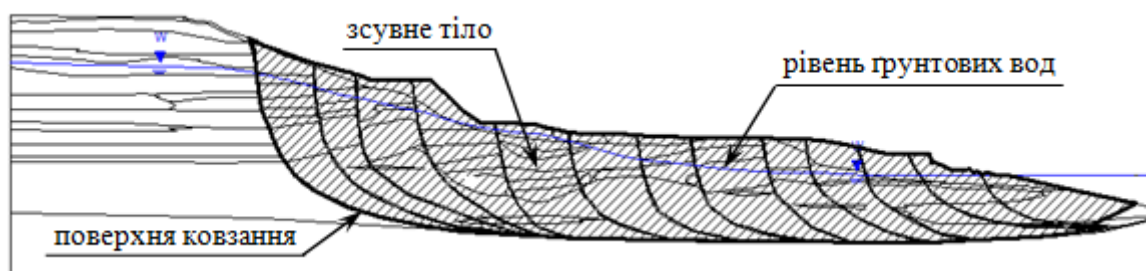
Загальний вид зсувного тіла (розрахунковий розріз 2-2)
